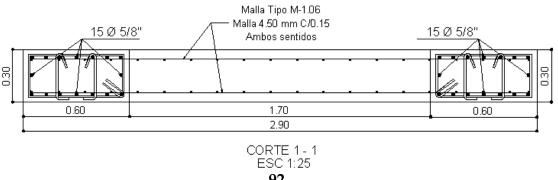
Vista en planta de muro estructural con elemento de borde de igual ancho que el muro
